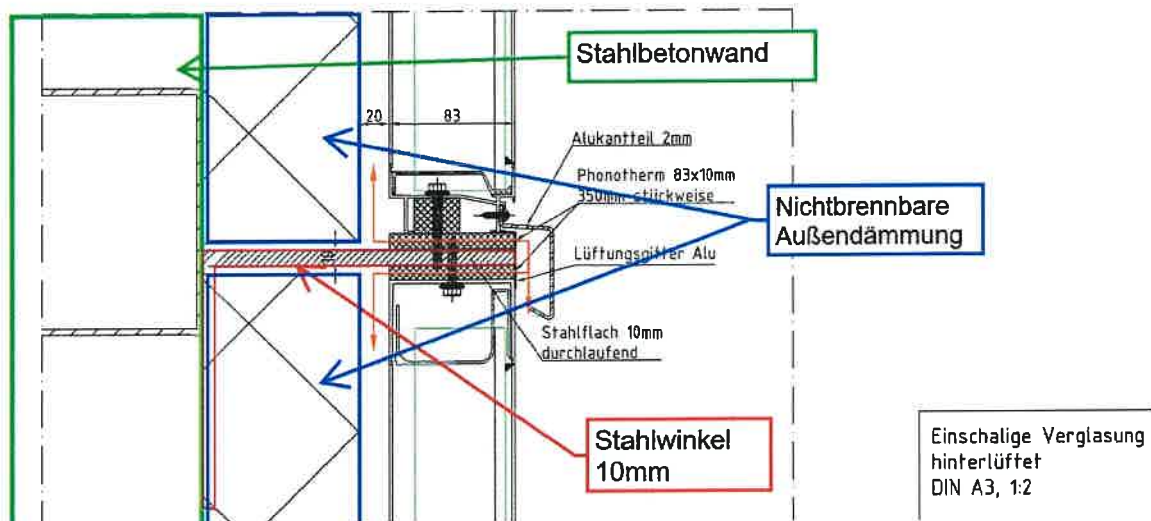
Prinzipskizze - Schnitt Stahlbetonwand Stahlwinkel - Brandsperre
